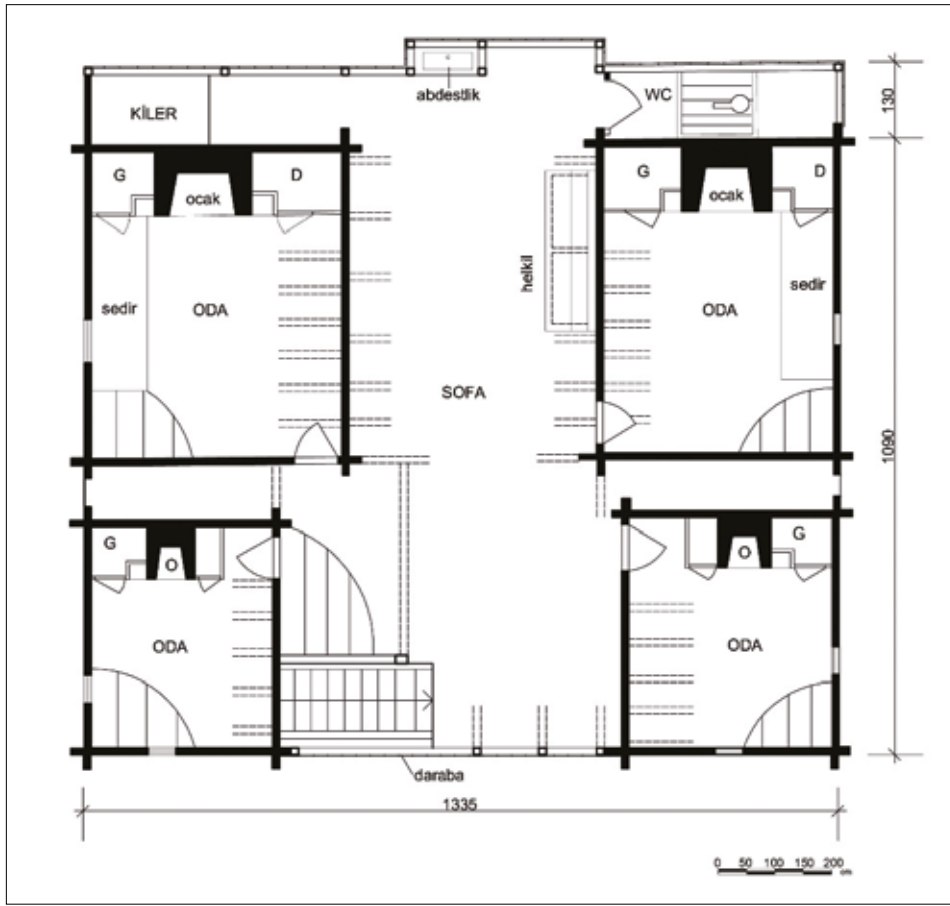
Kadir Kızılaslan Evi, üst kat planı, (2015) / Kadir Kızılaslan House, upper floor plan.
